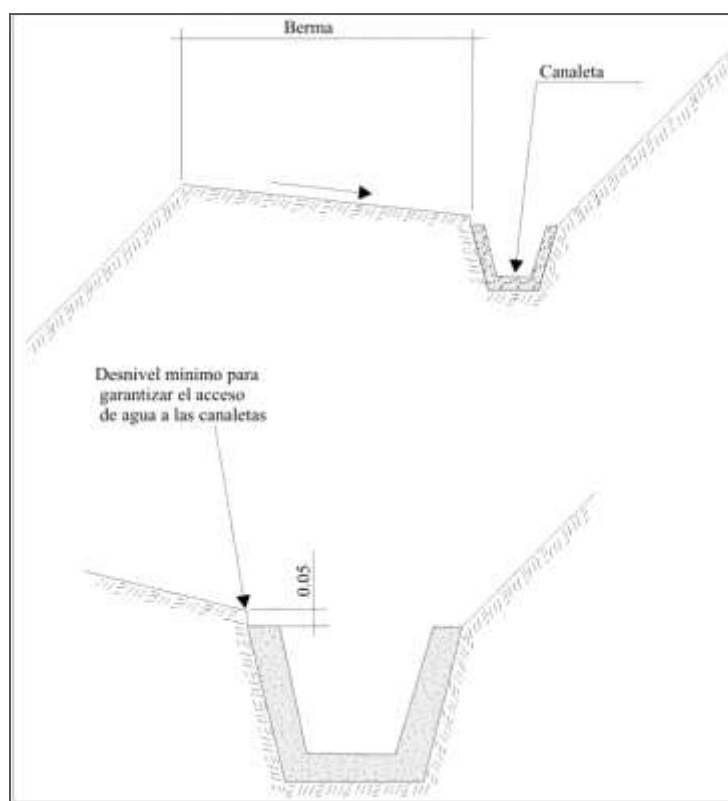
Detalle una canaleta de drenaje superficial (Zanjas de coronación).
